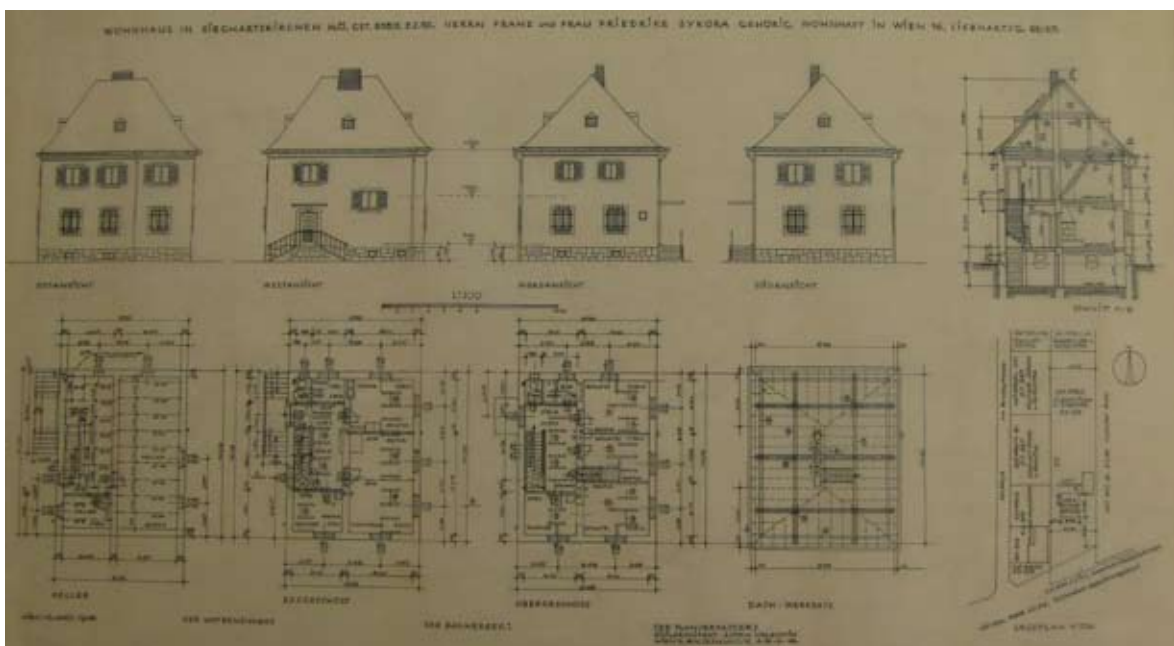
Plan 24.15: Anton Valentin. Wohnhaus in Sieghartskirchen N.Ö. GSt. 838/2, E.Z. 155. Herrn Franz und Frau Friedrike Sykora gehörig, wohnhaft in Wien 16, Liebhartsgr. 55/57. Ansichten, Schnitt, Grundrisse und Lageplan. Maßstab 1:100. 16. April 1948.
